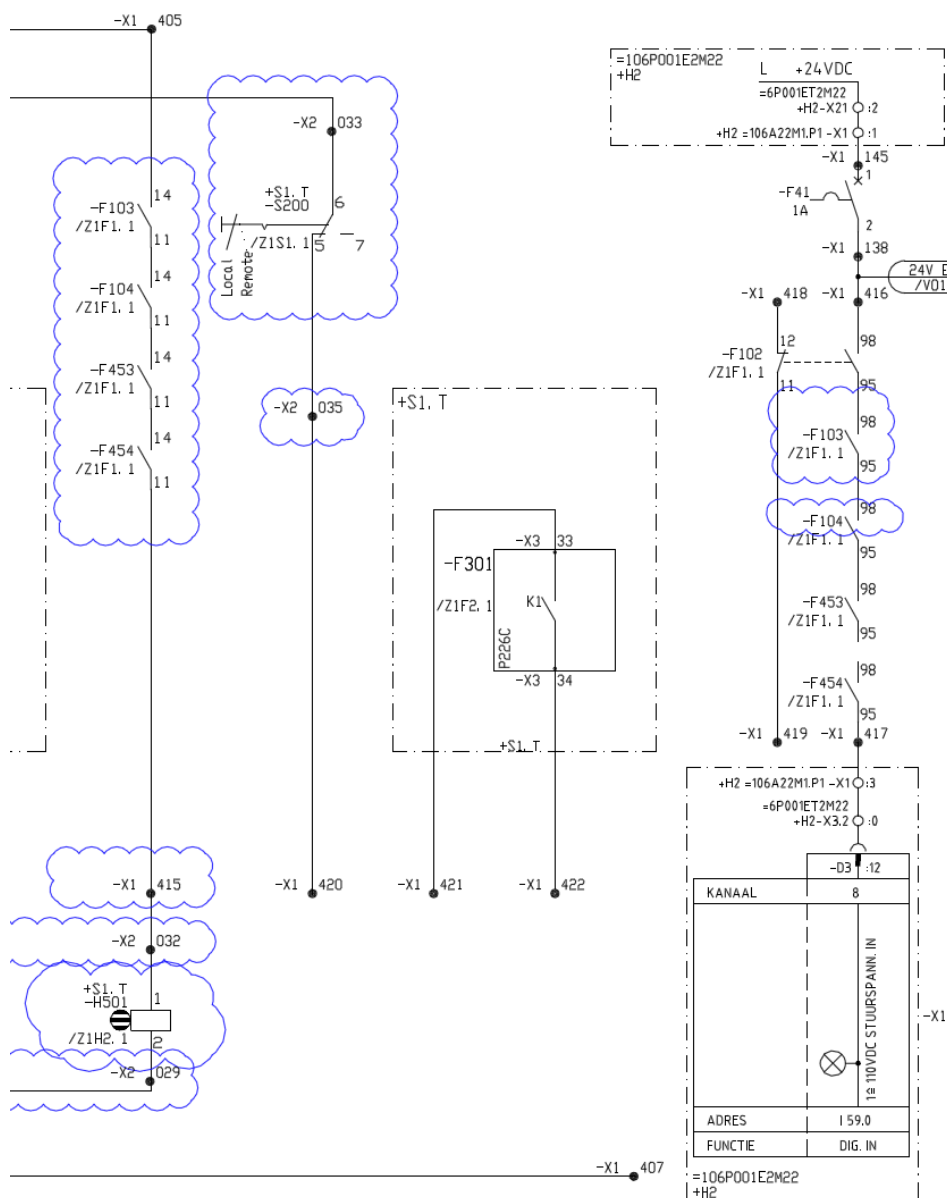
STROOMKRINGSCHEMA SIGNALERING 2/2
